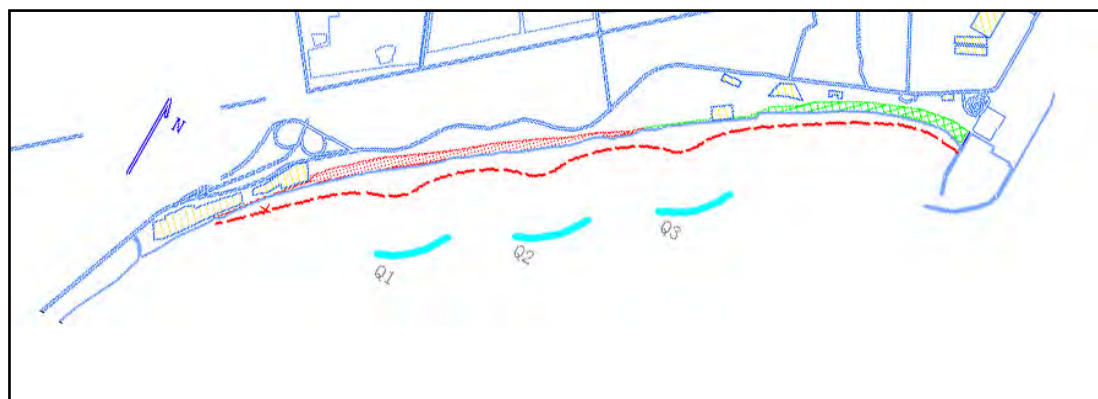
金梦海湾海滩整治修复工程平面布置图
